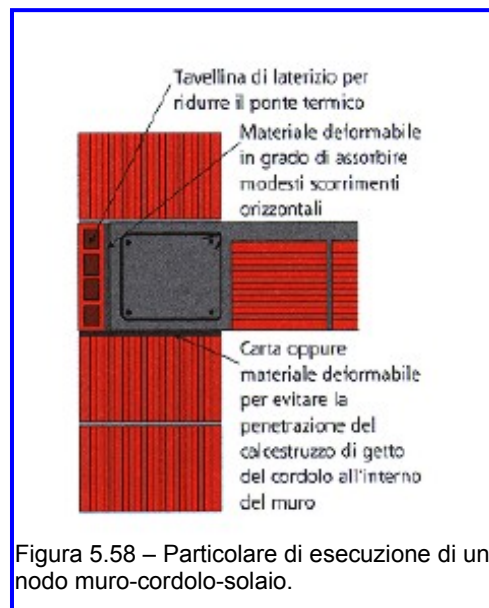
Particolare di esecuzione di un nodo muro-cordolo-solaio.
